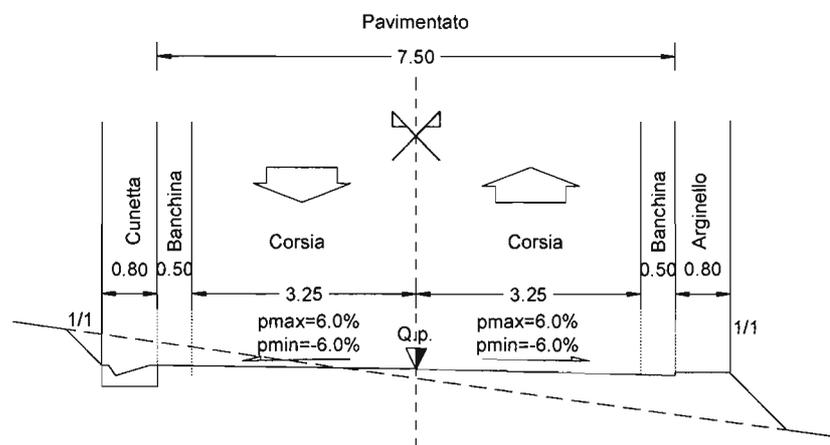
Sezione tipo Strada Statale Esistente tratto Svincolo Forch.
